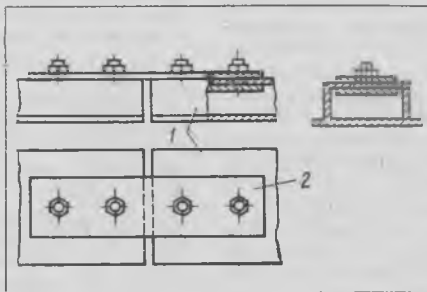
Конструкция шинопровода: 1 — продольная секция; 2 — накладка
